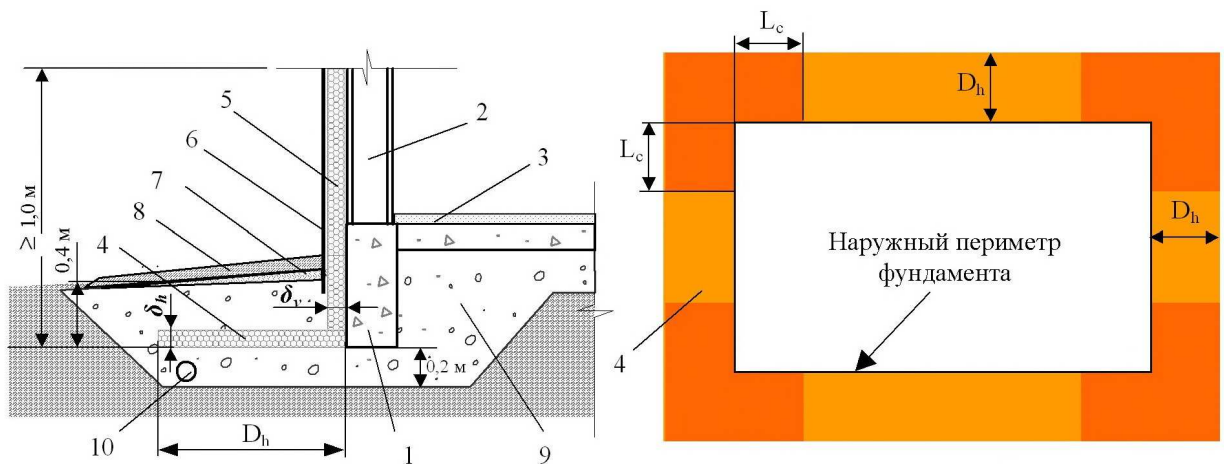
а. Схема укладки и параметры теплоизоляции «Пеноплэкс» в фундаментах отапливаемых зданий без теплоизоляции пола
